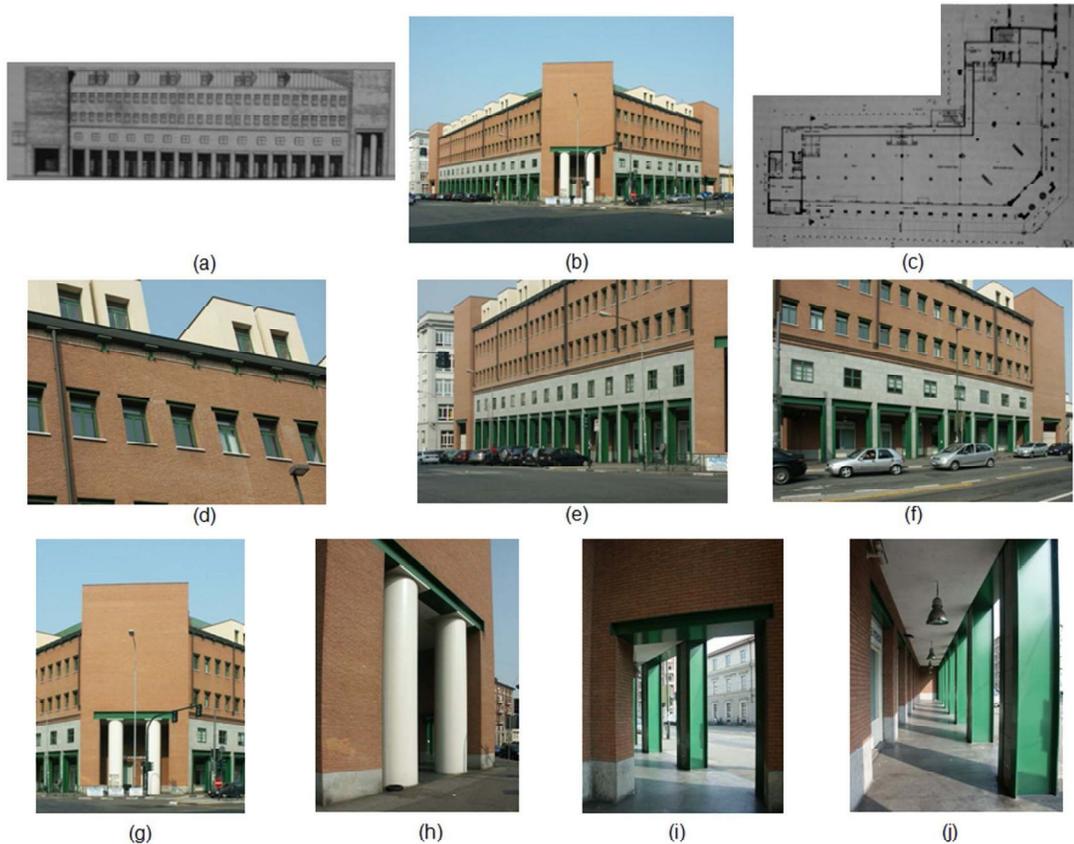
Aldo Rossi, Empresa Aurora, del Grupo GFT, Turín, Italia, (1984-1987): (a) Alzado lateral, (b) Vista exterior – fachada principal, (c) Planta arquitectónica baja, (d) Detalle exterior – Azotea, (e) y (f) Detalles exteriores – fachadas laterales, (g) Detalle exterior – Acceso principal, (h) Detalle exterior – columnas – acceso principal, (i) y (j) Detalle exterior – corredores.
